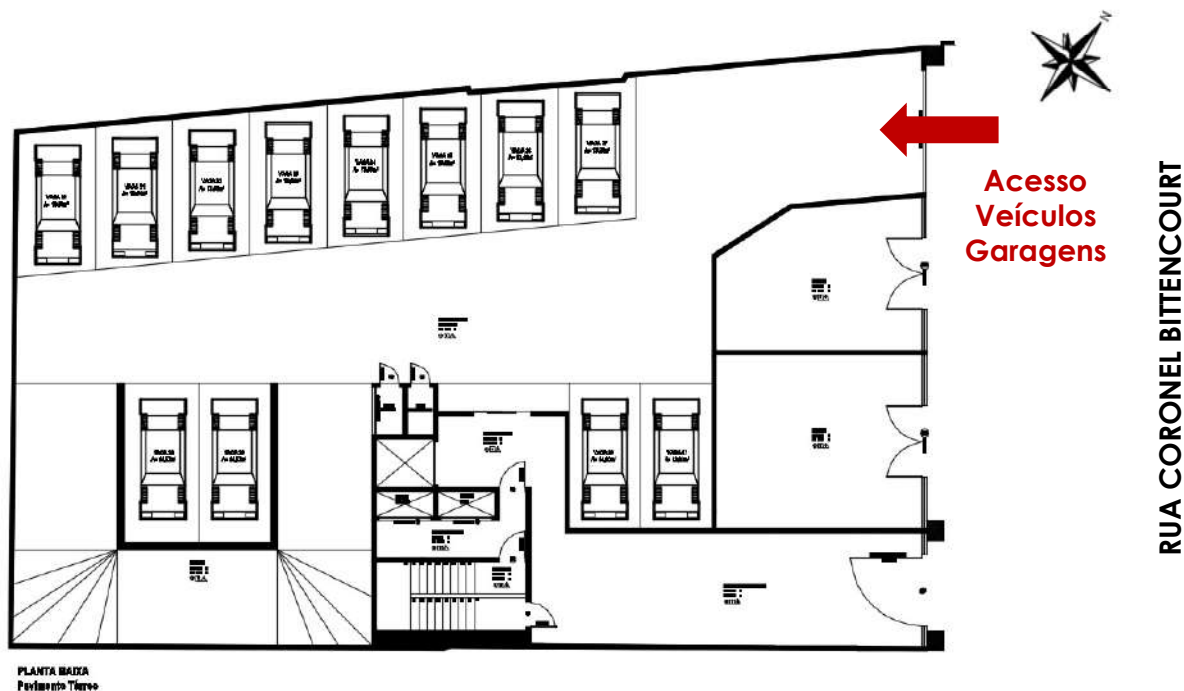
Planta Baixa Pavimento Térreo - Acesso de veículos
